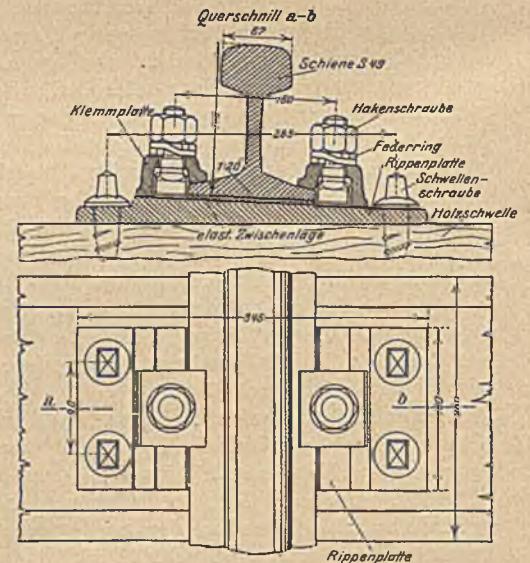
Rippenplattenoberbau (Form K) auf Holzschwellen.
